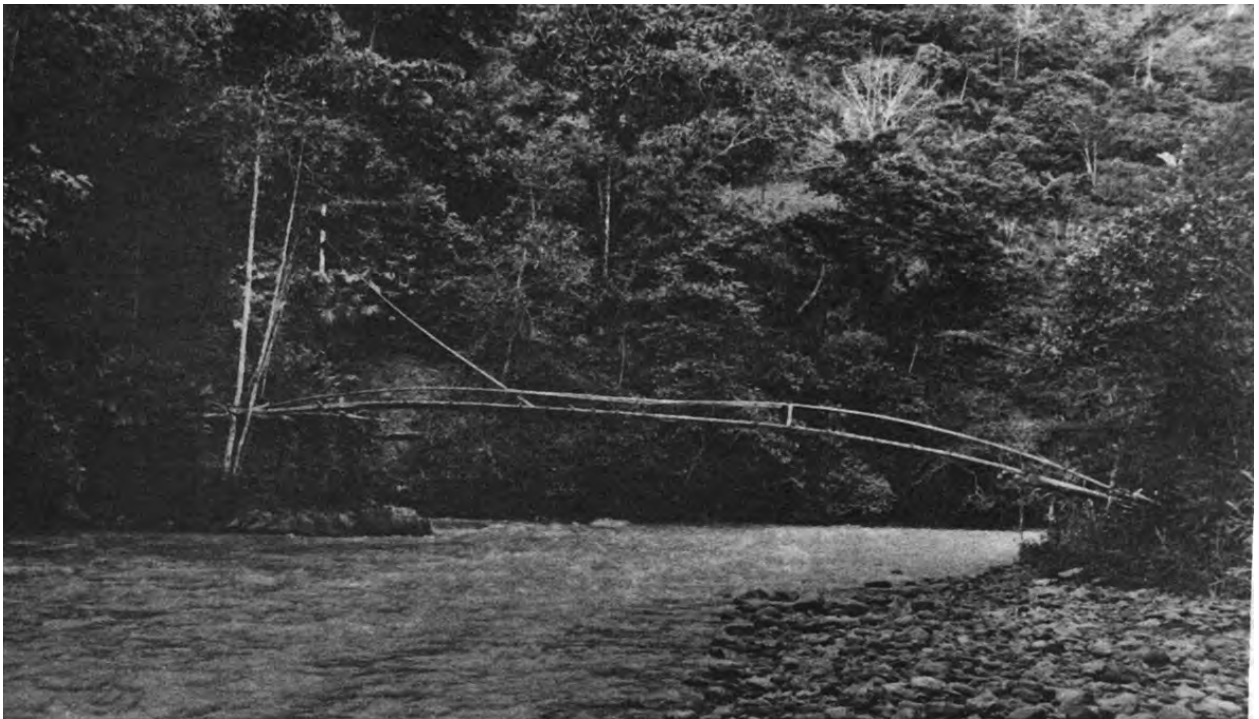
Puente colgante sobre el río San Juan, en Canchíbare
